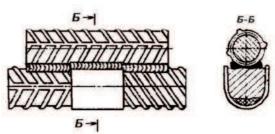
Способ усиления сварного стыка. Fig. 3. Method of amplification of a welded joint.
